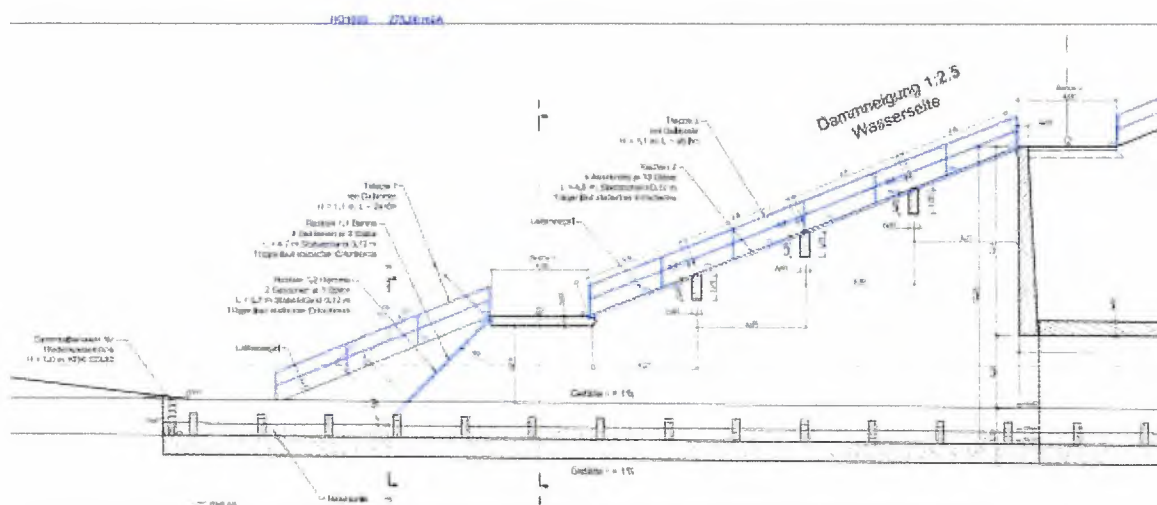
Schnitt durch das Einlaufbauwerk; aus Plan 12.5.4
